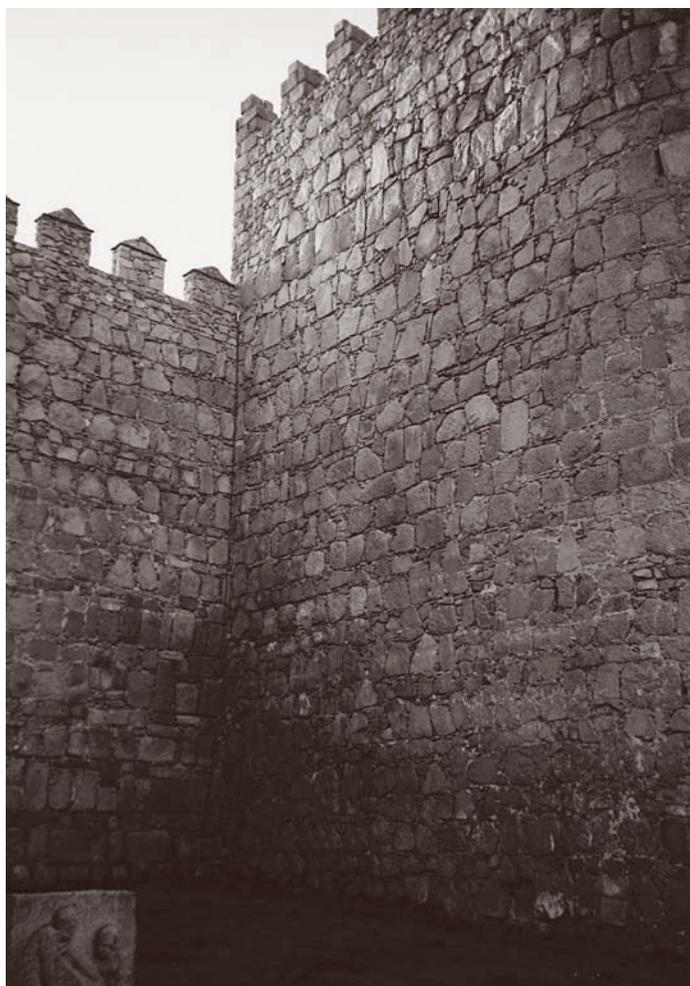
Cubo 3: cara sur, Puerta de San Vicente.
